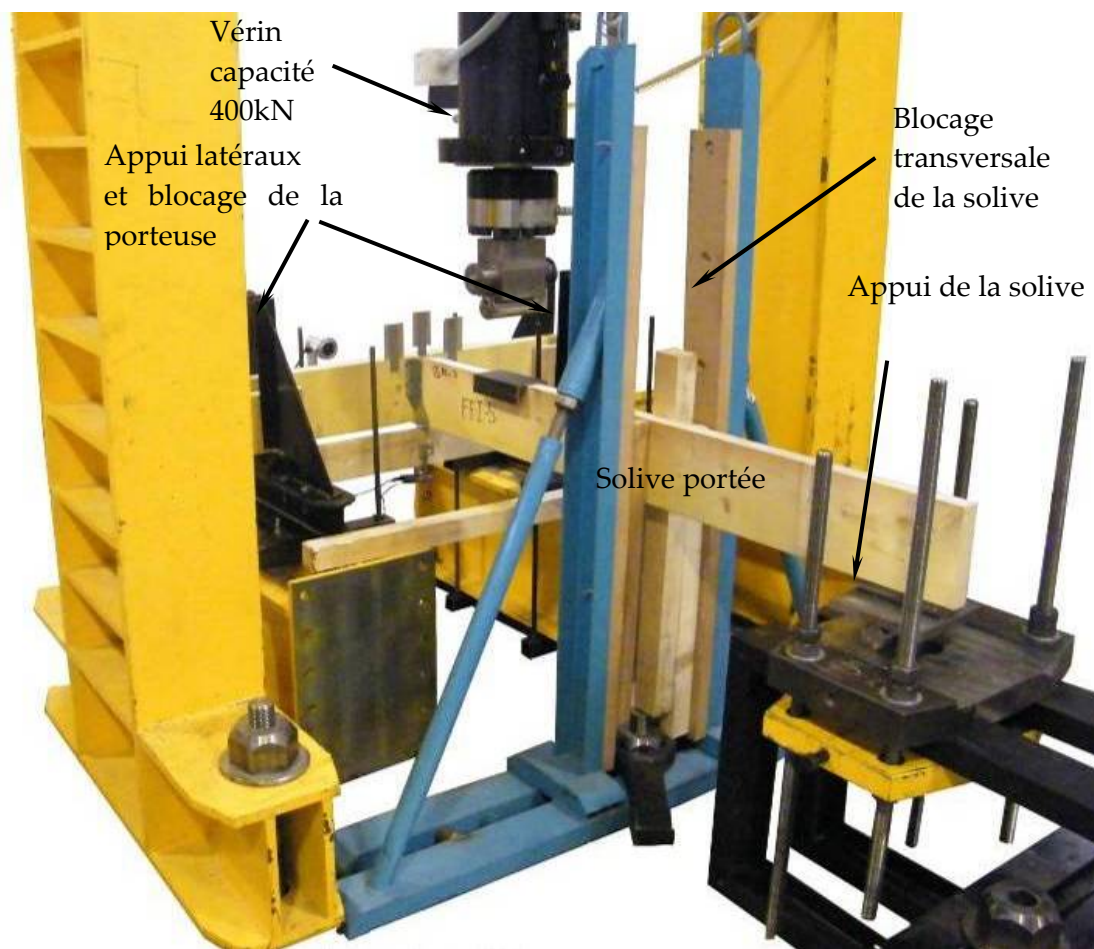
Montage expérimental de tests d'ancrage sur la dalle d'essais mécanique du LERMAB.
